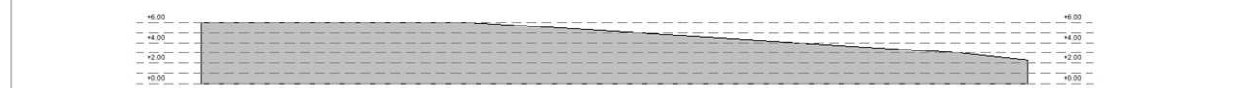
Perfil B-B' del terreno. Fuente: Elaboración propia, 2018.
